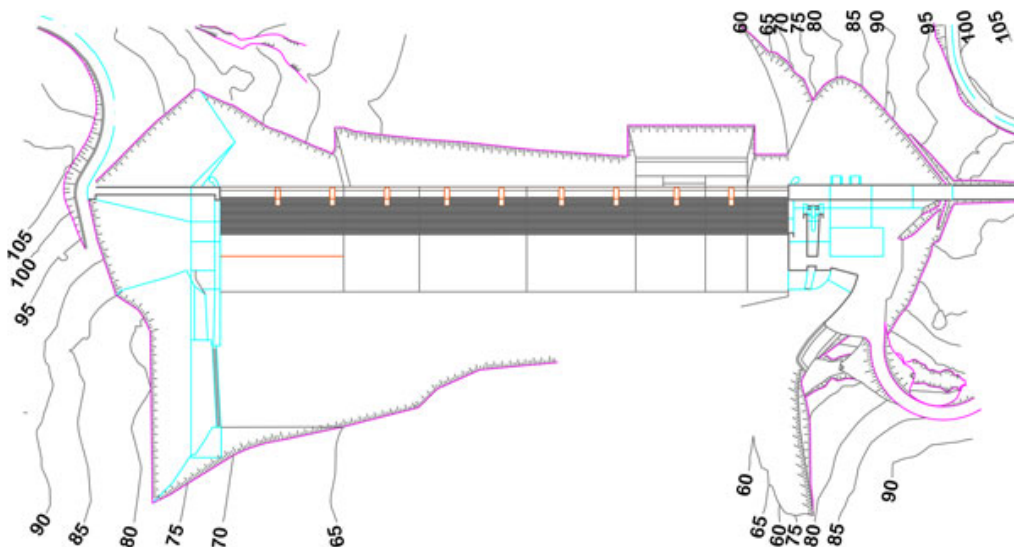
Desenvolvimento em planta da barragem do Pedrógão (INAG, 2008)
